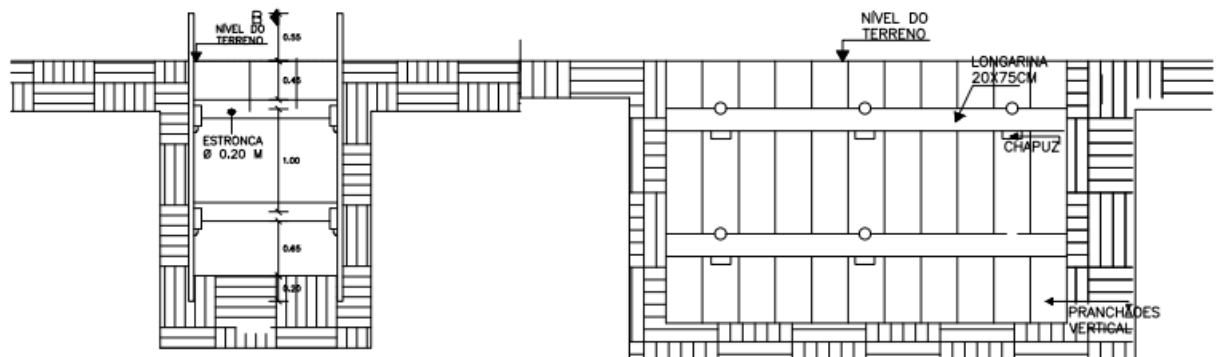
(a) Planta Baixa da Contenção Provisória tipo contínua
